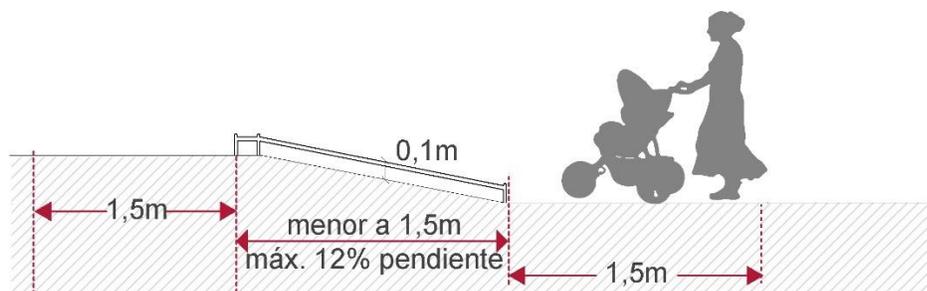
Rampas de longitud inferior a 1,5m requieren de protección lateral de mín. 0,1m.
